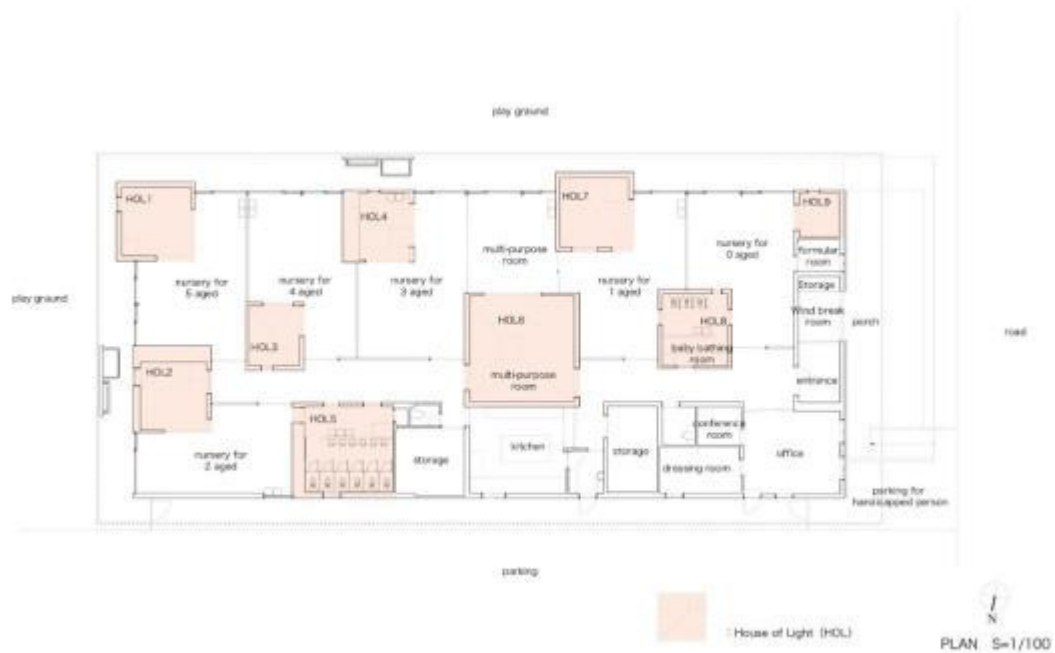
Escuela infantil Leimond, imagen de la planta general.
